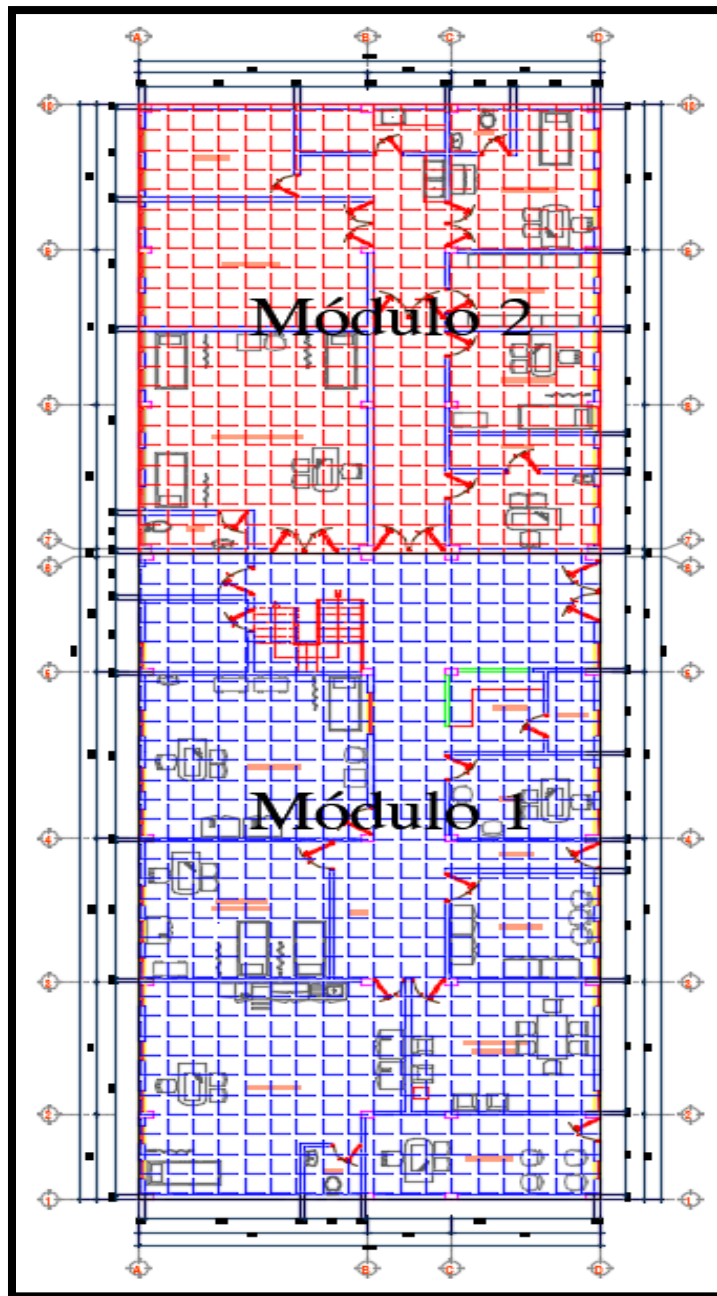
Plano arquitectónico 1er nivel del módulo 1 y 2.
